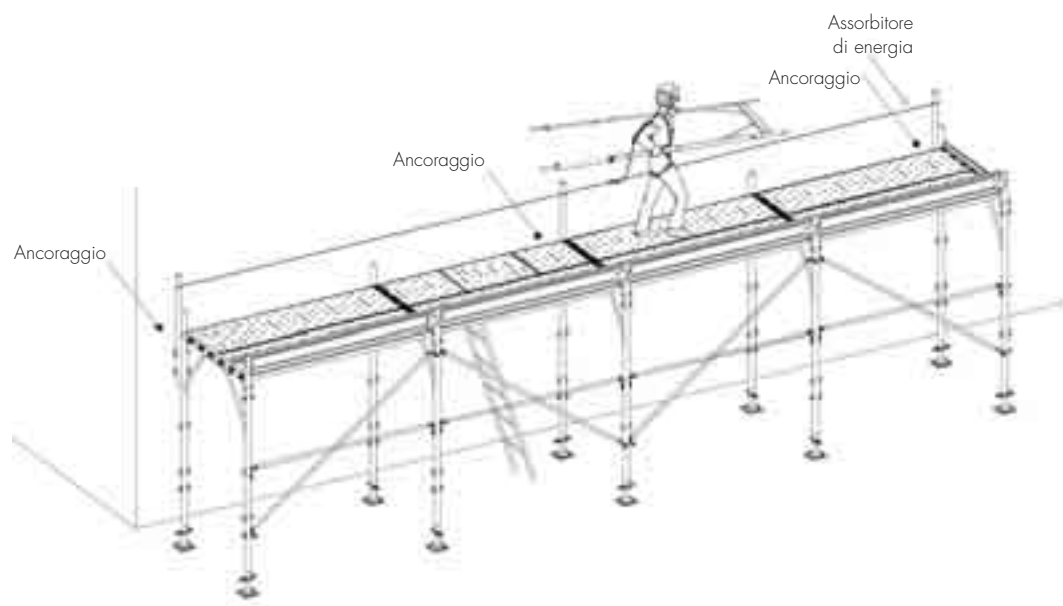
Fase operativa di montaggio del secondo livello: linea di ancoraggio posta ad un livello più elevato rispetto al piano di lavoro
